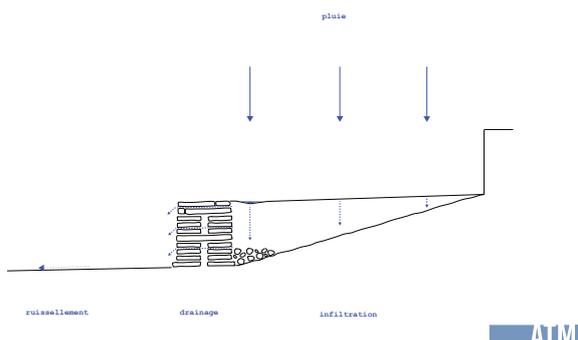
Les murs en pierres sèches, un savoir-faire sur la maîtrise des eaux de ruissellement
